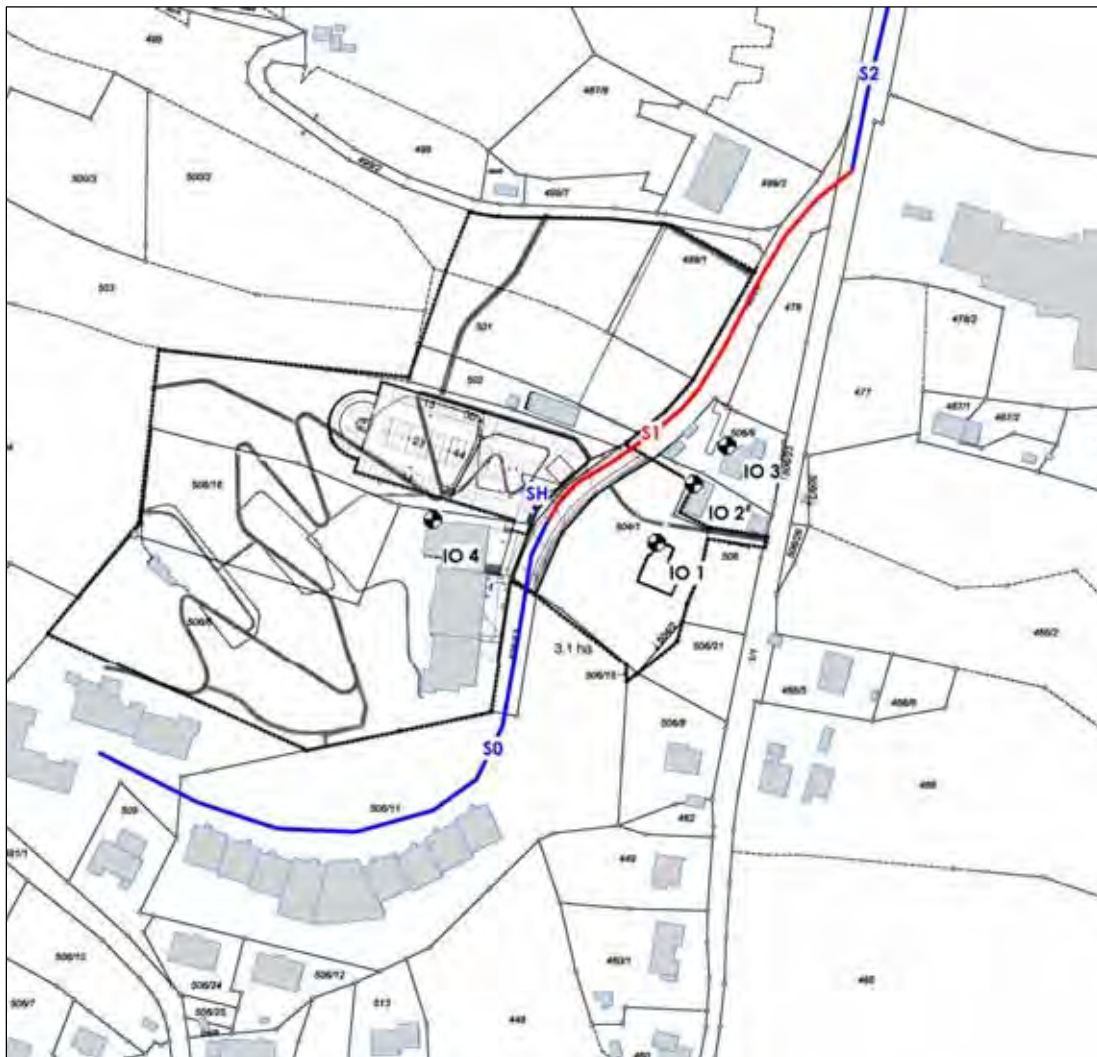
Lageplan mit Darstellung der relevanten Schallquelle für den Straßenverkehr
